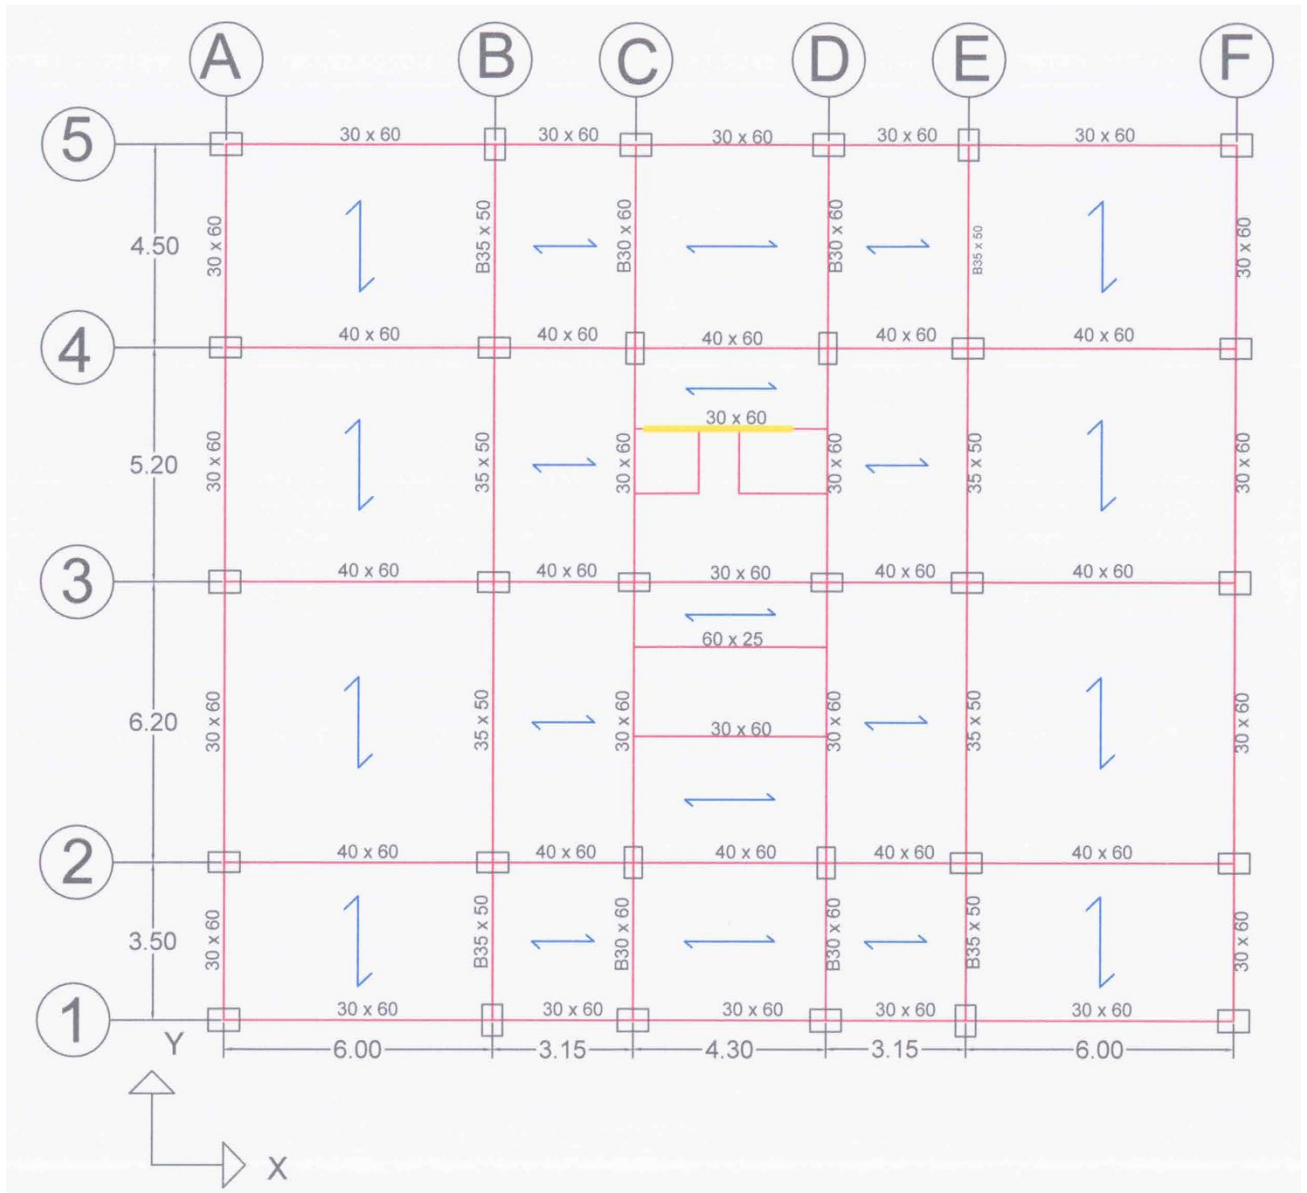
ENVIGADO DE PLANTA TIPO
